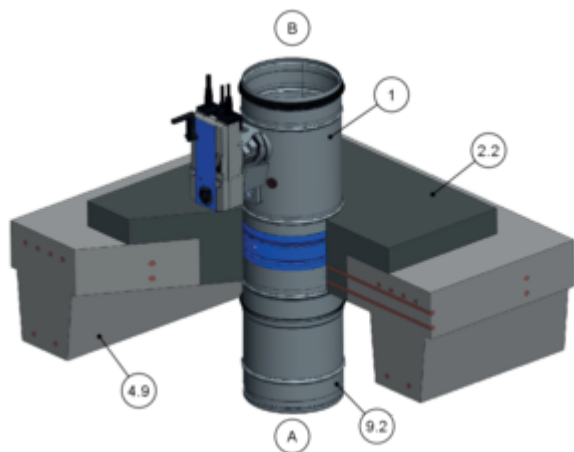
Installazione a base di malta in un soffitto a camera cava, raffigurata in verticale (si applica anche alla disposizione sospesa)
